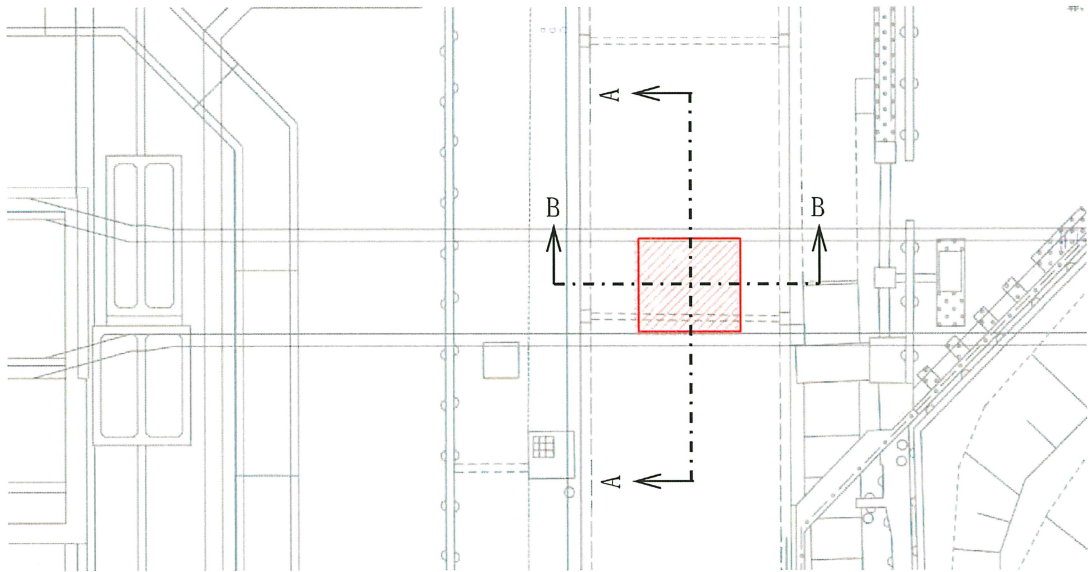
(1) 取放水路流路縮小工（第1号機放水路） 平面図
